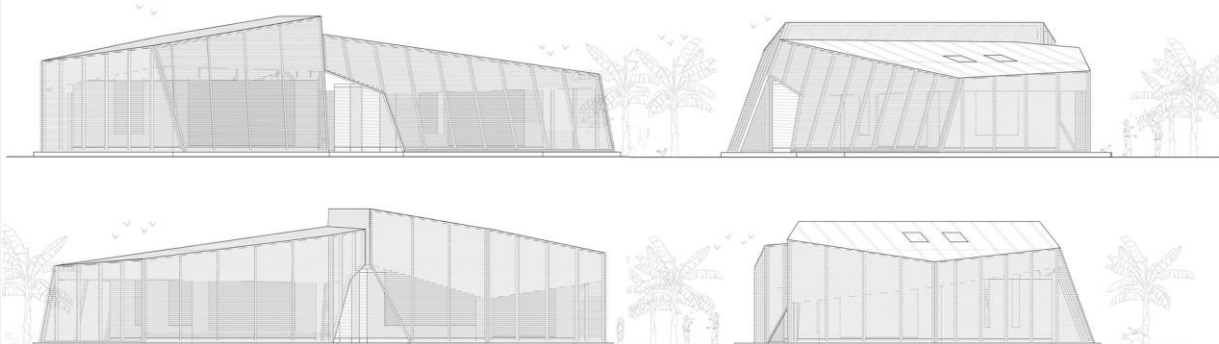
Vista de fachada lateral de proyecto. Fuente: ArchDaily
